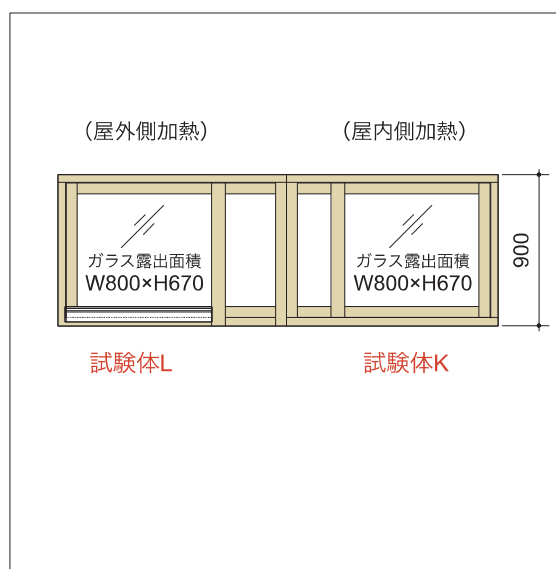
試験体概要(片引き窓) (寸法単位: mm)
